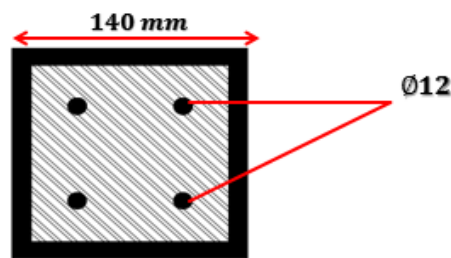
Coupe transversale d'un poteau mixte (tube métallique carrée creux)
